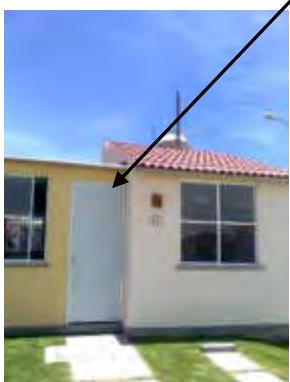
detalles de fisuras y juntas fuente autor
